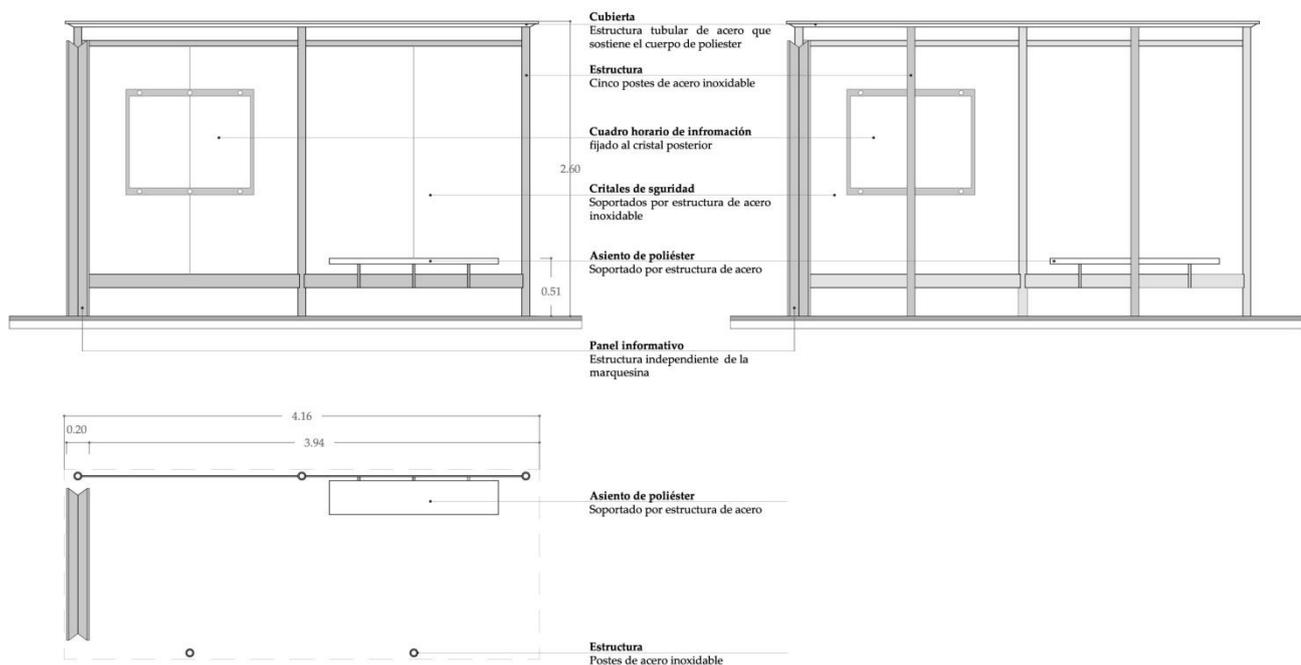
Alzado y planta marquesina modelo Super Pal.li. Dibujos de la autora.
